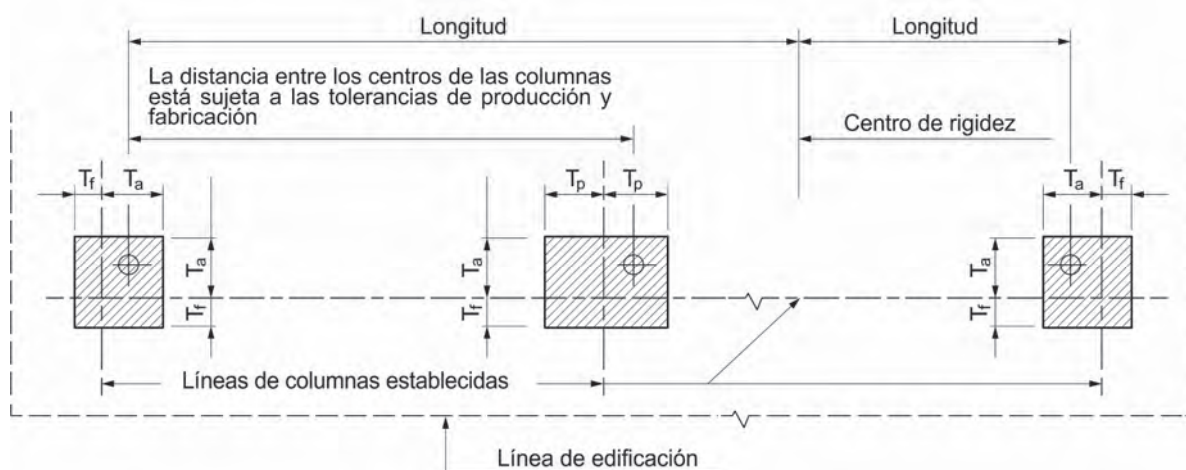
Tolerancias en planta para la ubicación de las columnas
